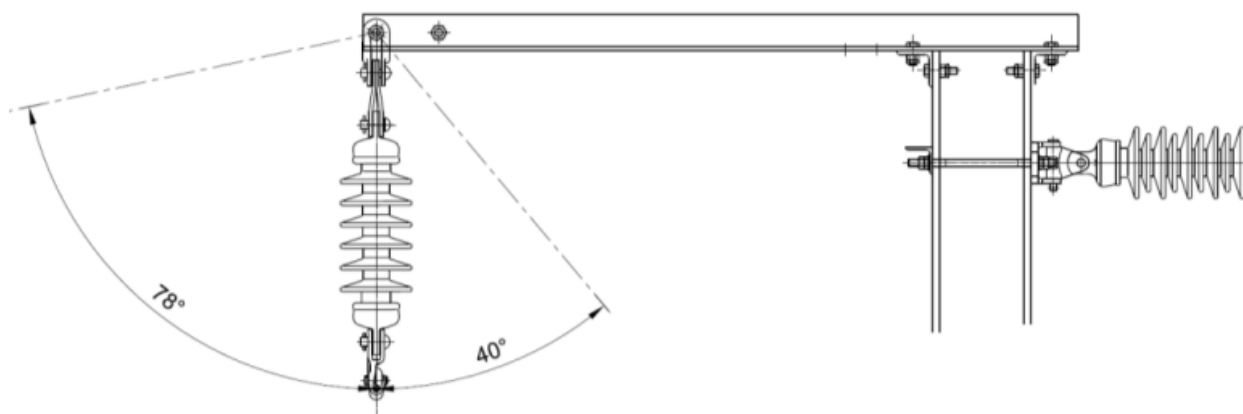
Montagem do feeder – Pormenor da montagem para o lado do campo
